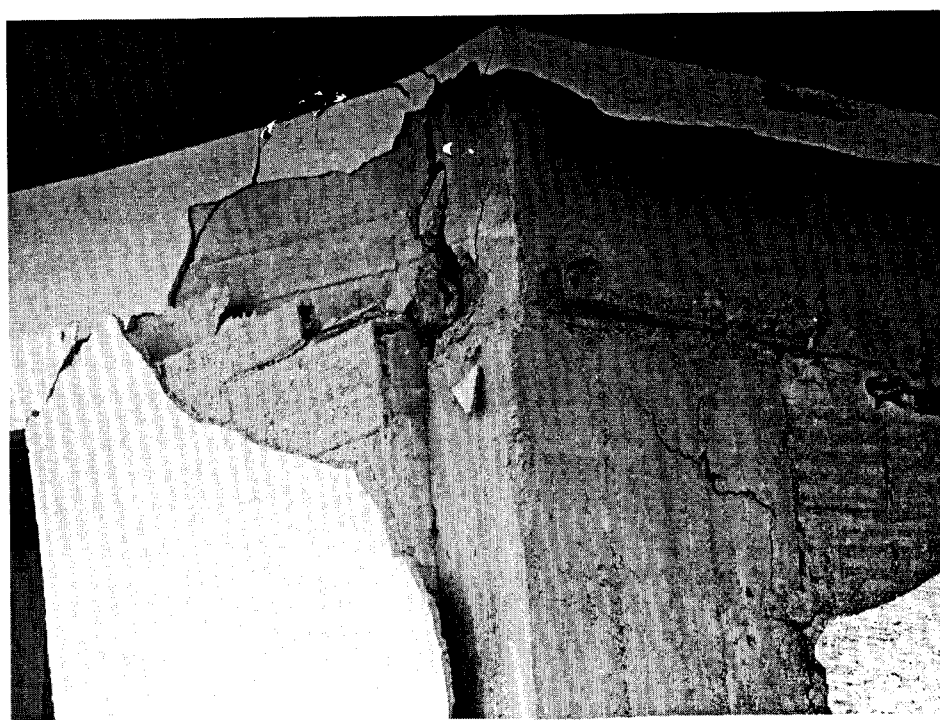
Deficiente detallado del refuerzo, falta de anclaje y de adherencia.
